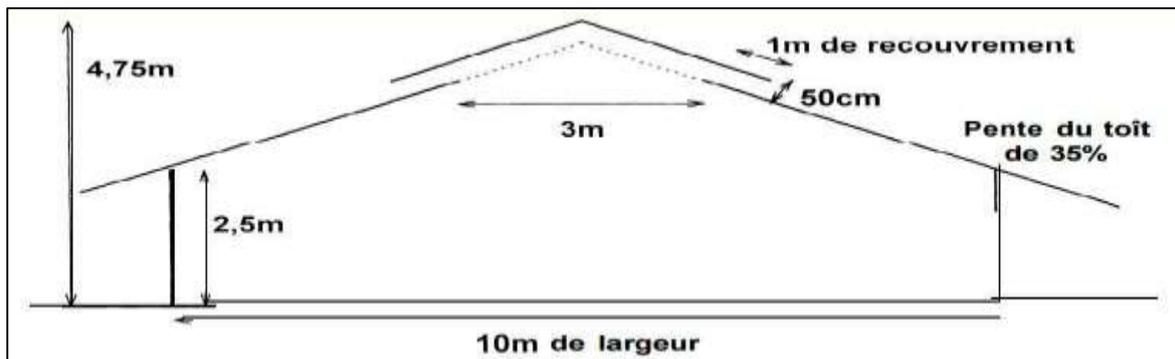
Plan du bâtiment d'élevage (Kouzoukenda t.n, 2000)
